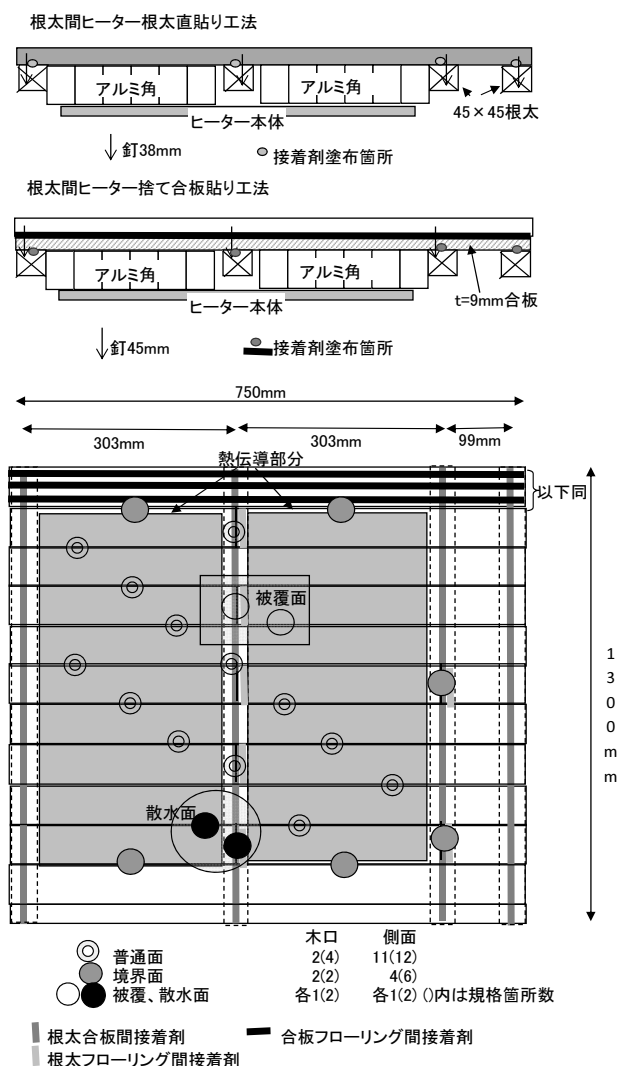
施工面 - 耐熱ランニング試験の工法別断面と測定箇所
